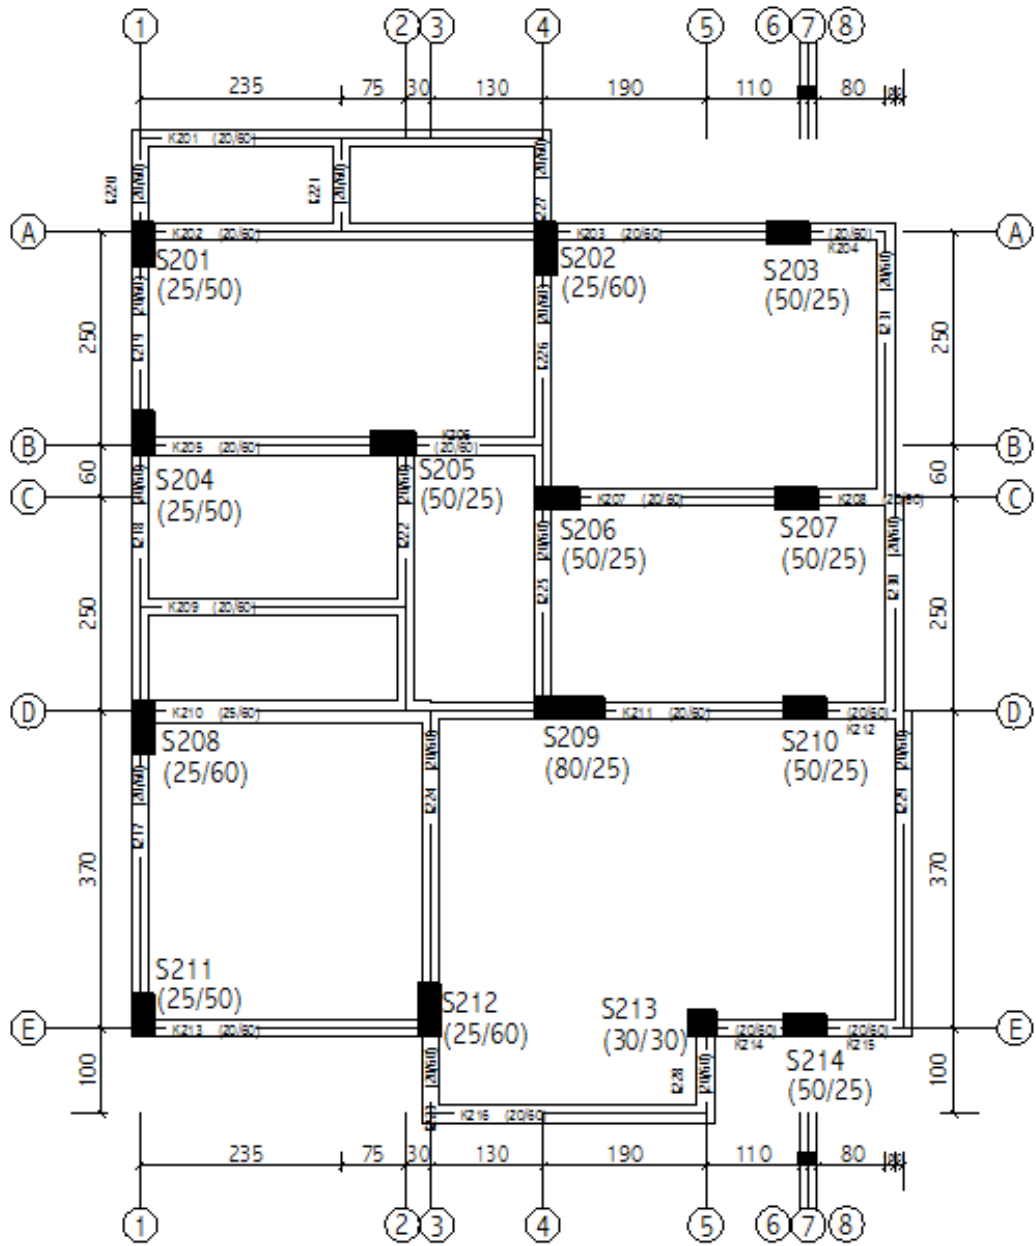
4K-B6 nolu binanın kalıp planı
